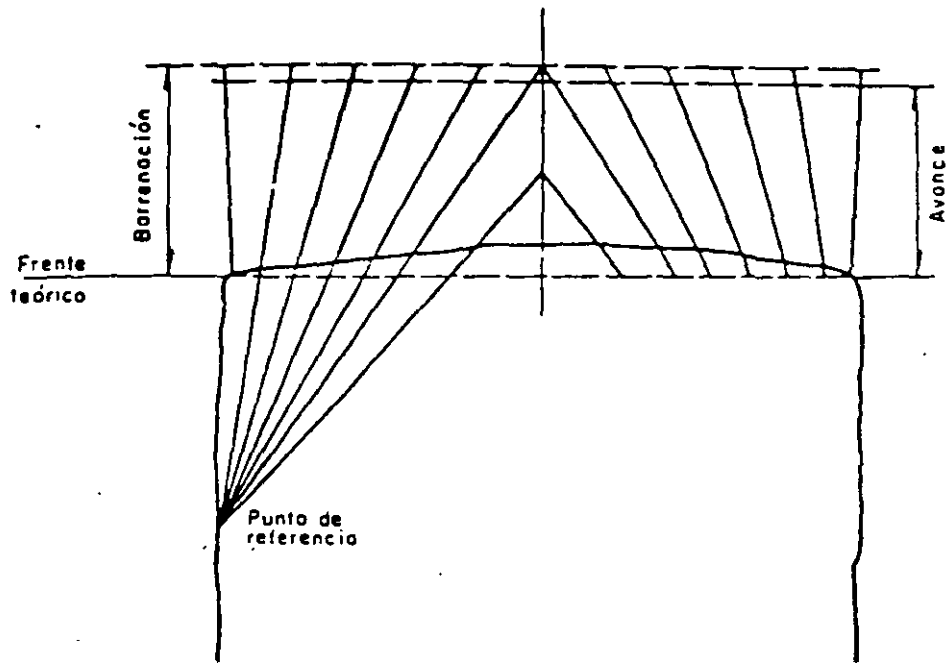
Distribución en planta de los barrenos de la cuña y los de fuera de la cuña
